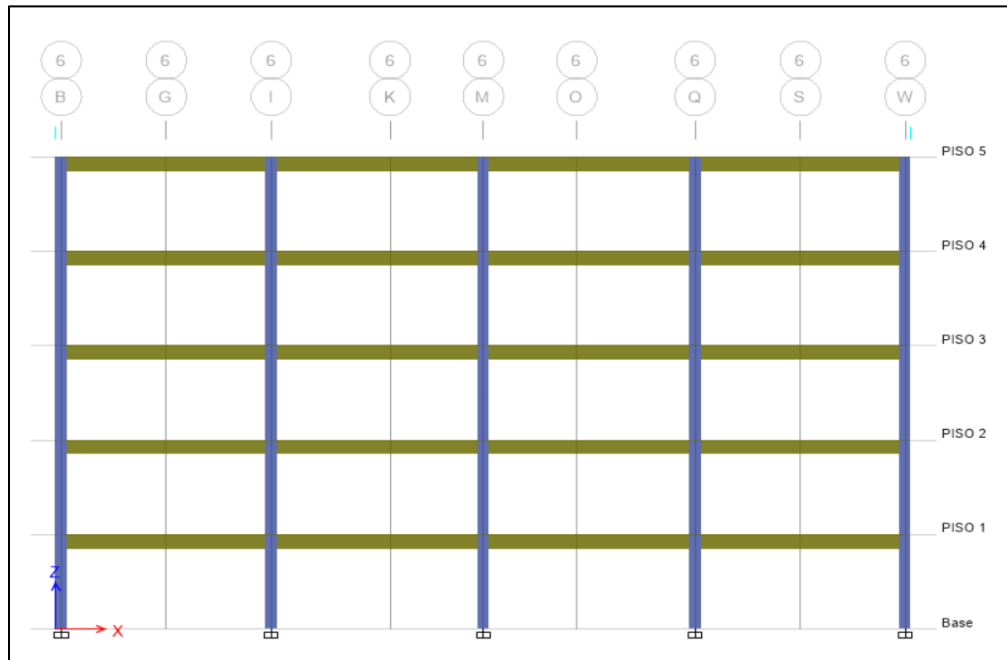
Vistas 3D - Edificación de 5 niveles con cubierta en placa
